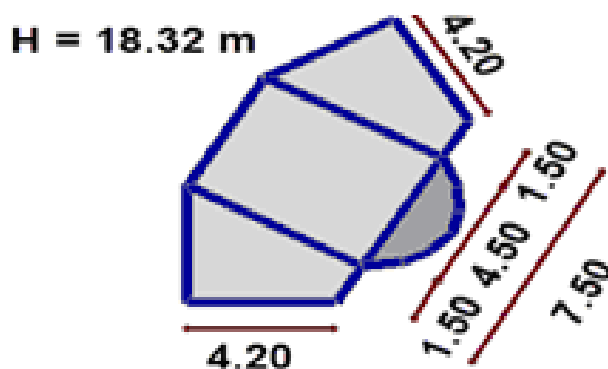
Vue en plan 2D, le plancher de 4^{ème} étage (terrace2)
